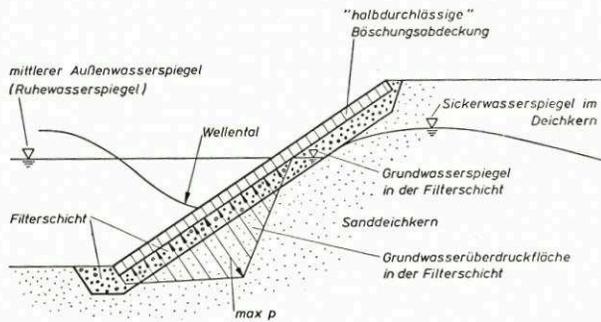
Grundwasserüberdruck unter einer „halboffenen“ Böschungsabdeckung auf einer Filterschicht, d. h. bei Nichteinhaltung der Filterregeln in der obersten Schicht der Böschungsabdeckung
